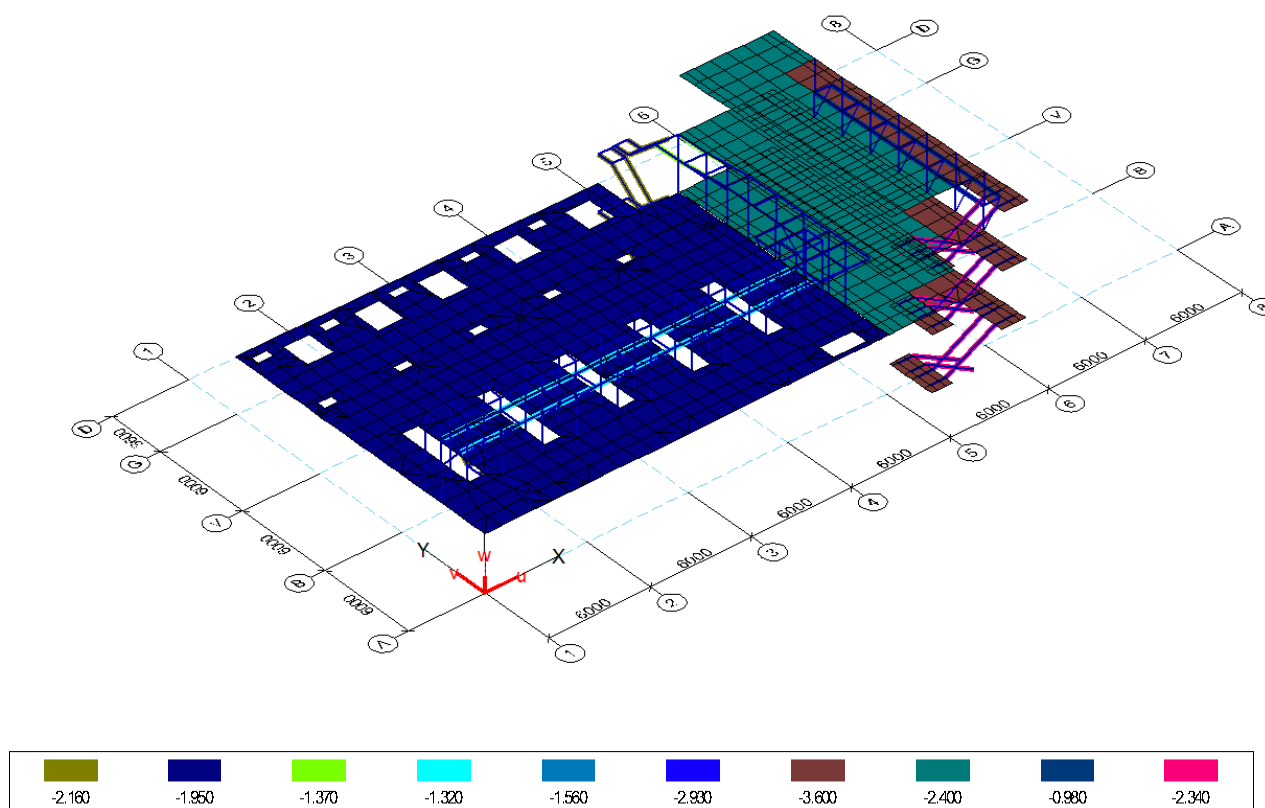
Эксплуатационная нагрузка на перекрытия на от 3,300 до 8,000
